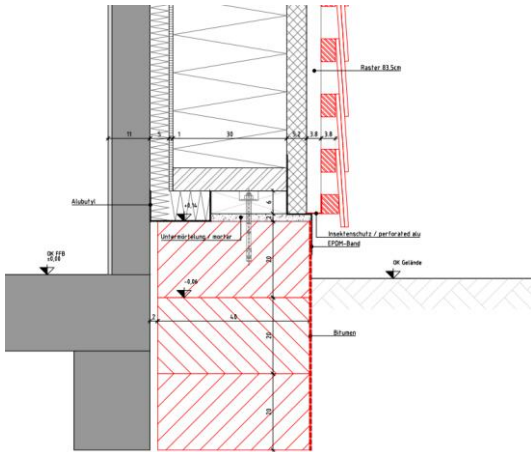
Raccord entre panneaux et fondations (coupe)
